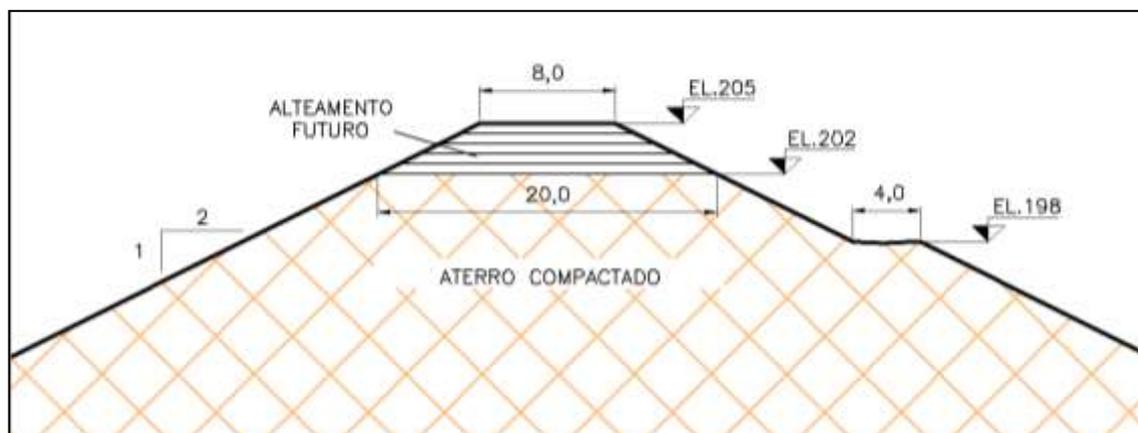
Detalhe esquemático de alteamento das paredes do SP-19 da elevação 202,0m para elevação 205,0 por linha de centro.
